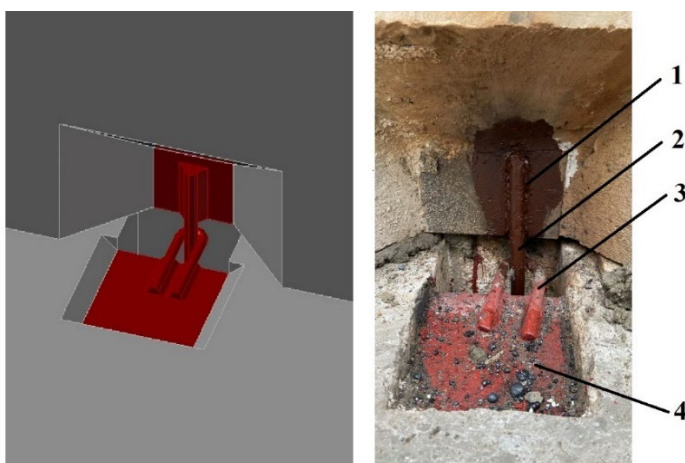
Сварной горизонтальный упругоподатливый стык панелей (Каталог 5.2, Архитектурное бюро АБ-1): 1-сварной шов, 2-анкерный выпуск стеновой панели, 3-стержень, соединяющий плиту перекрытия и стеновые панели, 4-пластина закладной детали
